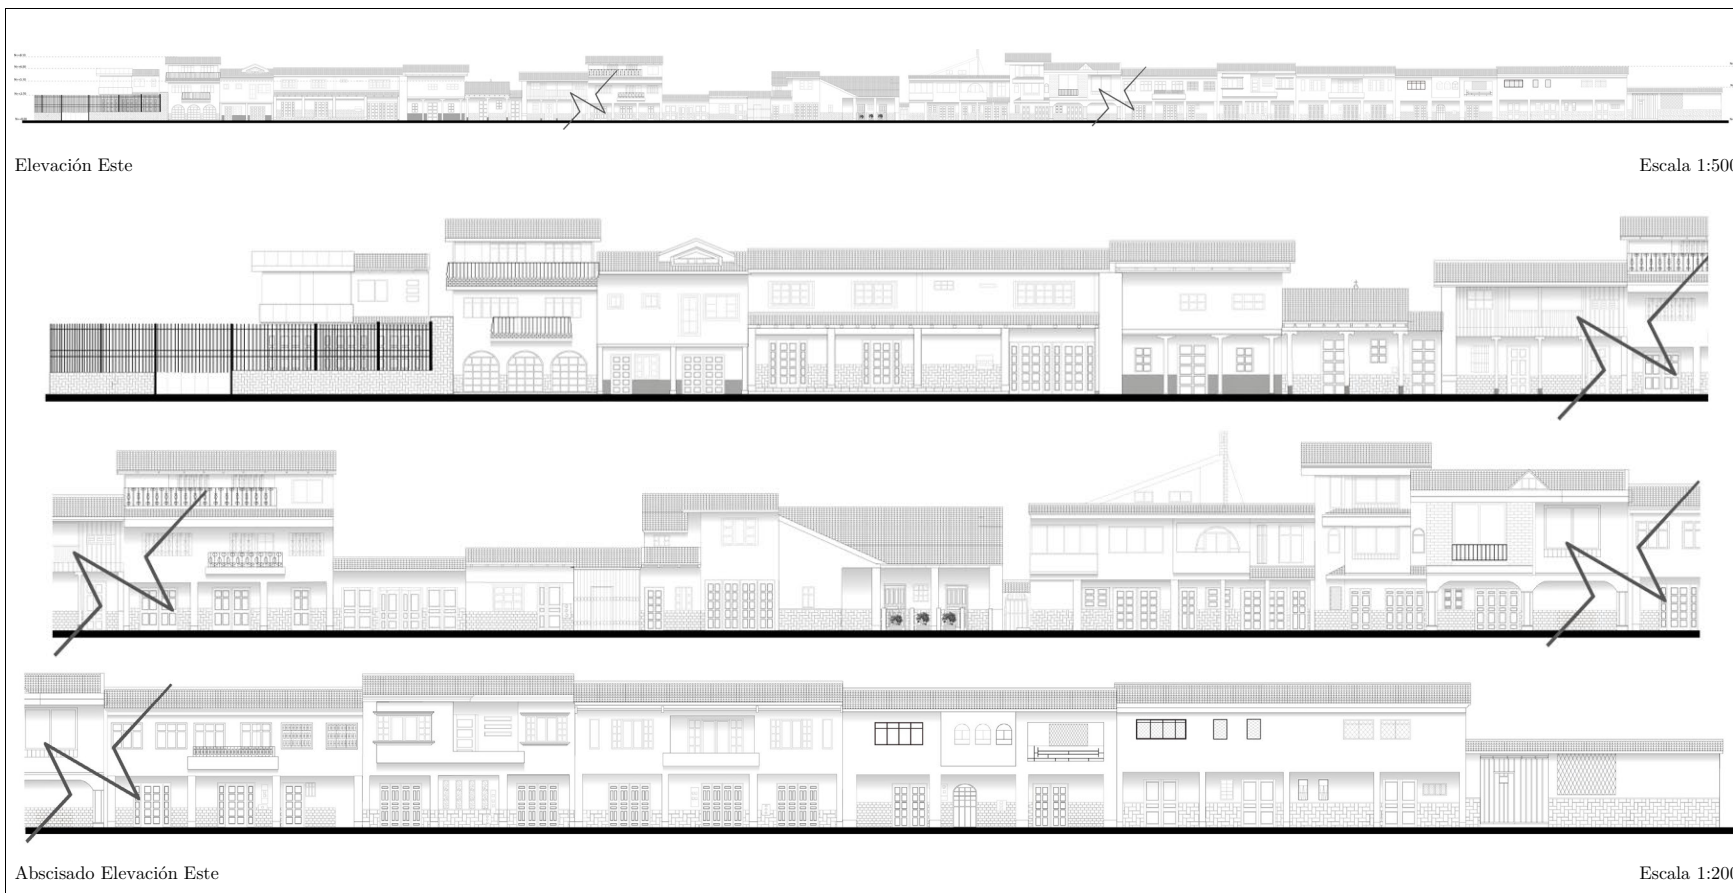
Elevaciones este. Fuente y Elaboración: Autoras.
